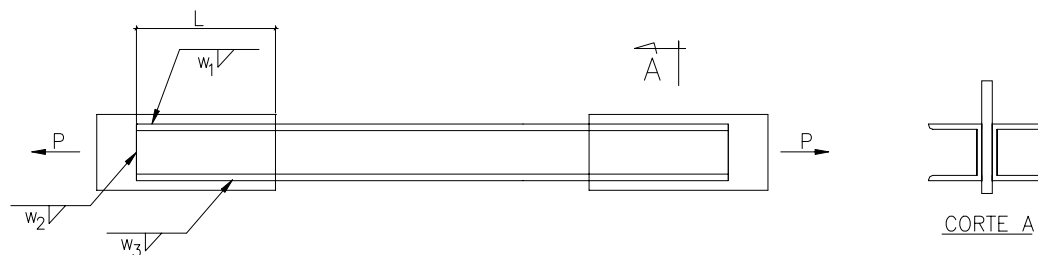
Configuração das amostras para barras com perfil U, soldadas para testes
